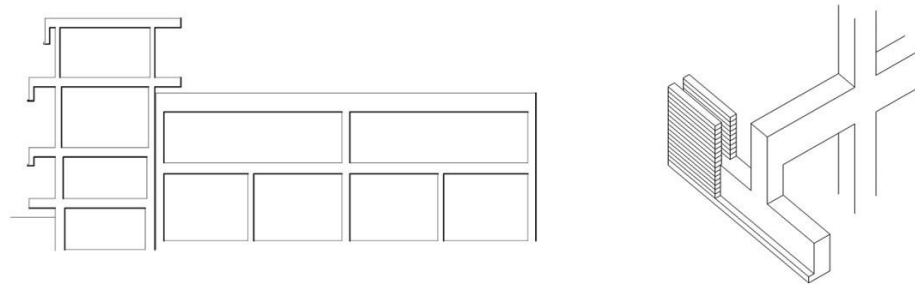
Pórticos del cuerpo frontal con detalle de viga dintel y esquema en planta con juntas de dilatación (VM/P191/T116). Arriba, esquemas pórticos frontal y de naves y viga dintel (autor).
